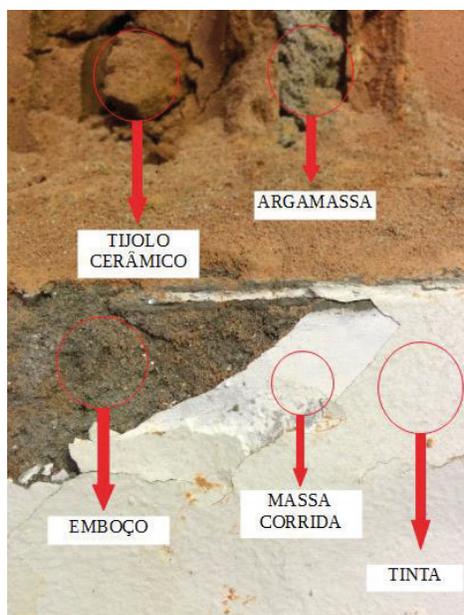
Prospecção na parede originalmente construída em 1942 no pavilhão de Construção Civil, na qual podem-se identificar as camadas de revestimento constituintes.
